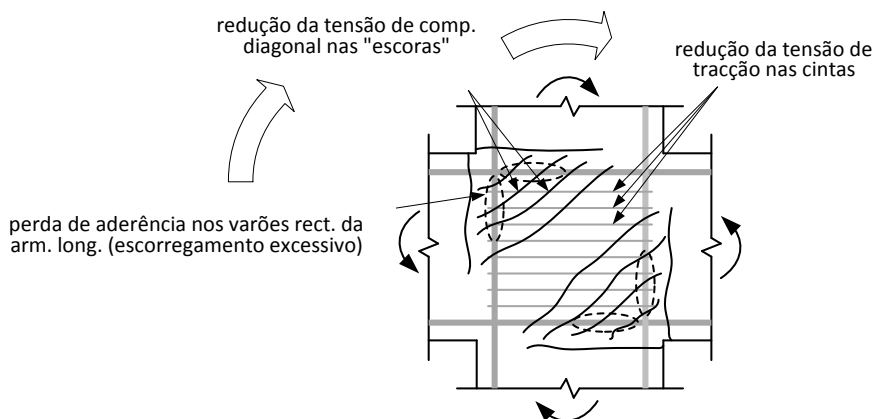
Efeito da perda de aderência entre os varões das armaduras longitudinais rectilíneas do pilar e das vigas e o betão envolvente.
